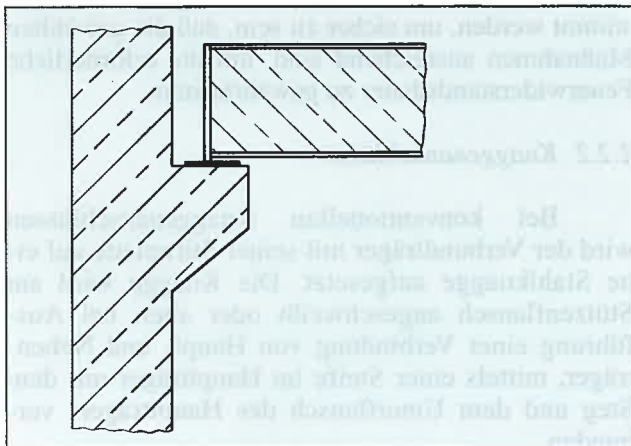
Auflagerung eines Verbundträgers auf der Stahlbetonkonsole einer Fertigteilstütze
